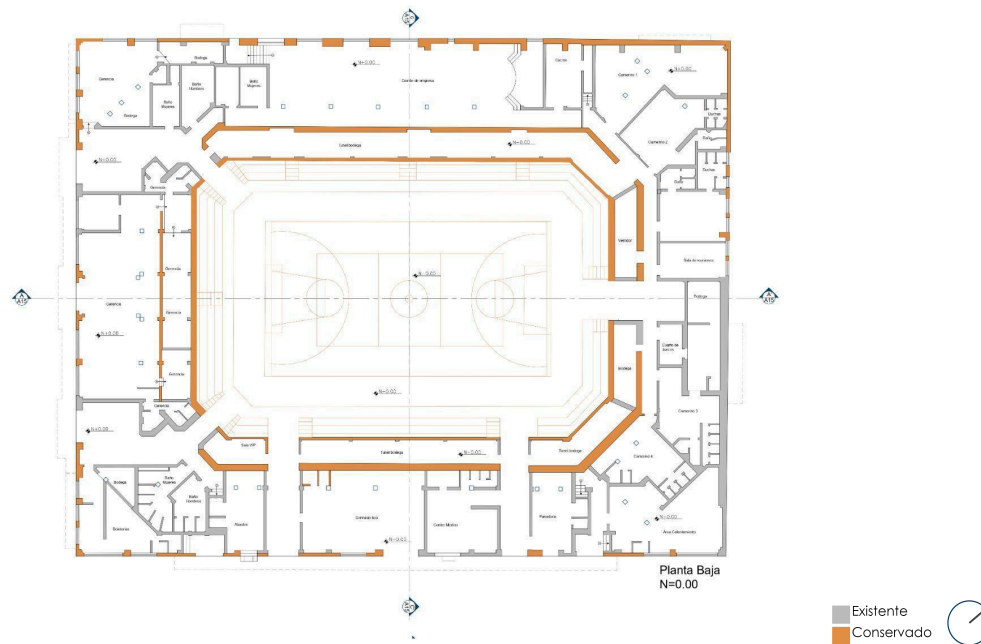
Planta actual Coliseo Julio César Hidalgo.
